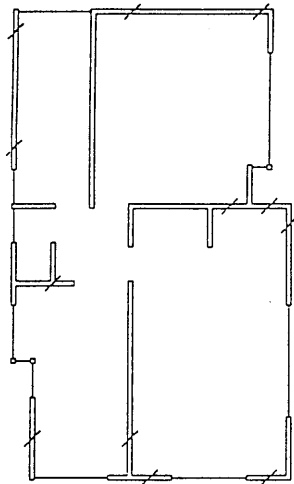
解析対象建築物平面図 (No.15, No.16)
